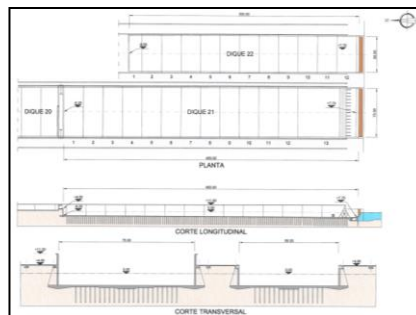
Planta e cortes-tipo das docas 21 e 22
